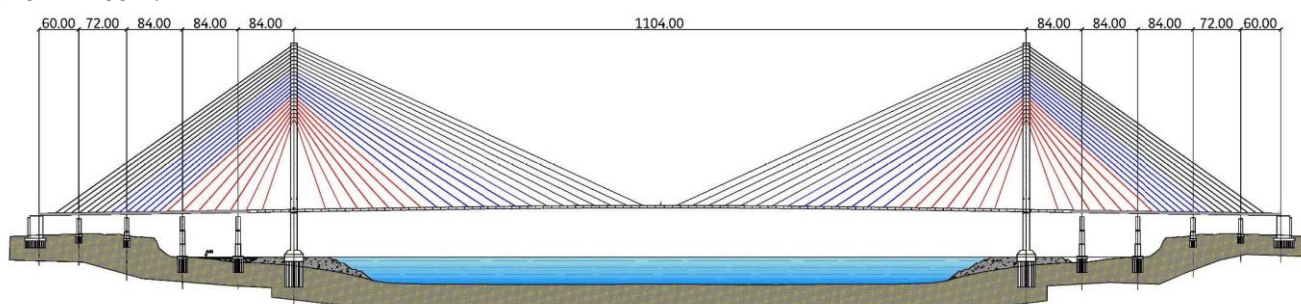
Schiță Podul Russky (Mellier, 2014)
